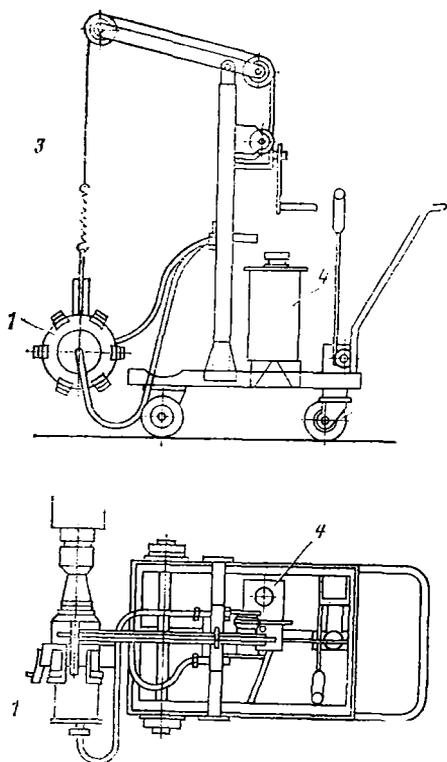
Насосная станция с гидро-домкратом на подвеске:
